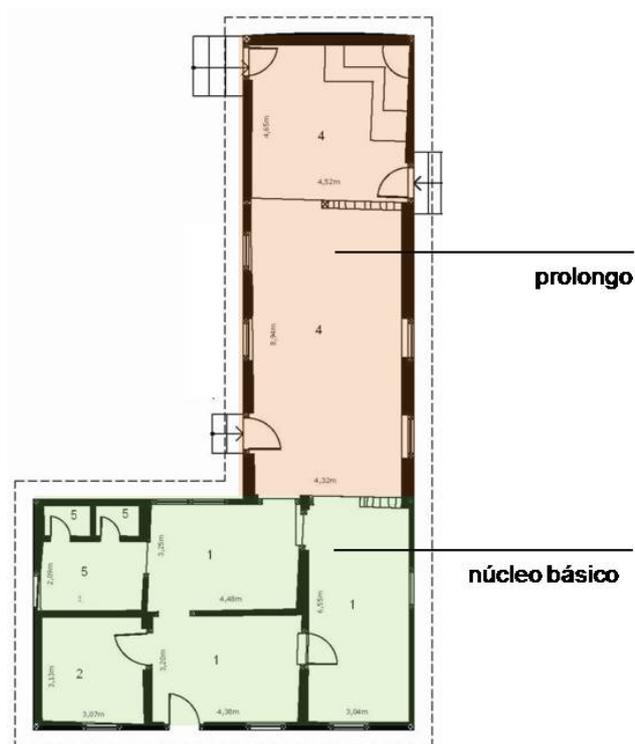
Planta baixa da morada da Fazenda Velha, destacados núcleo básico e prolongo.
